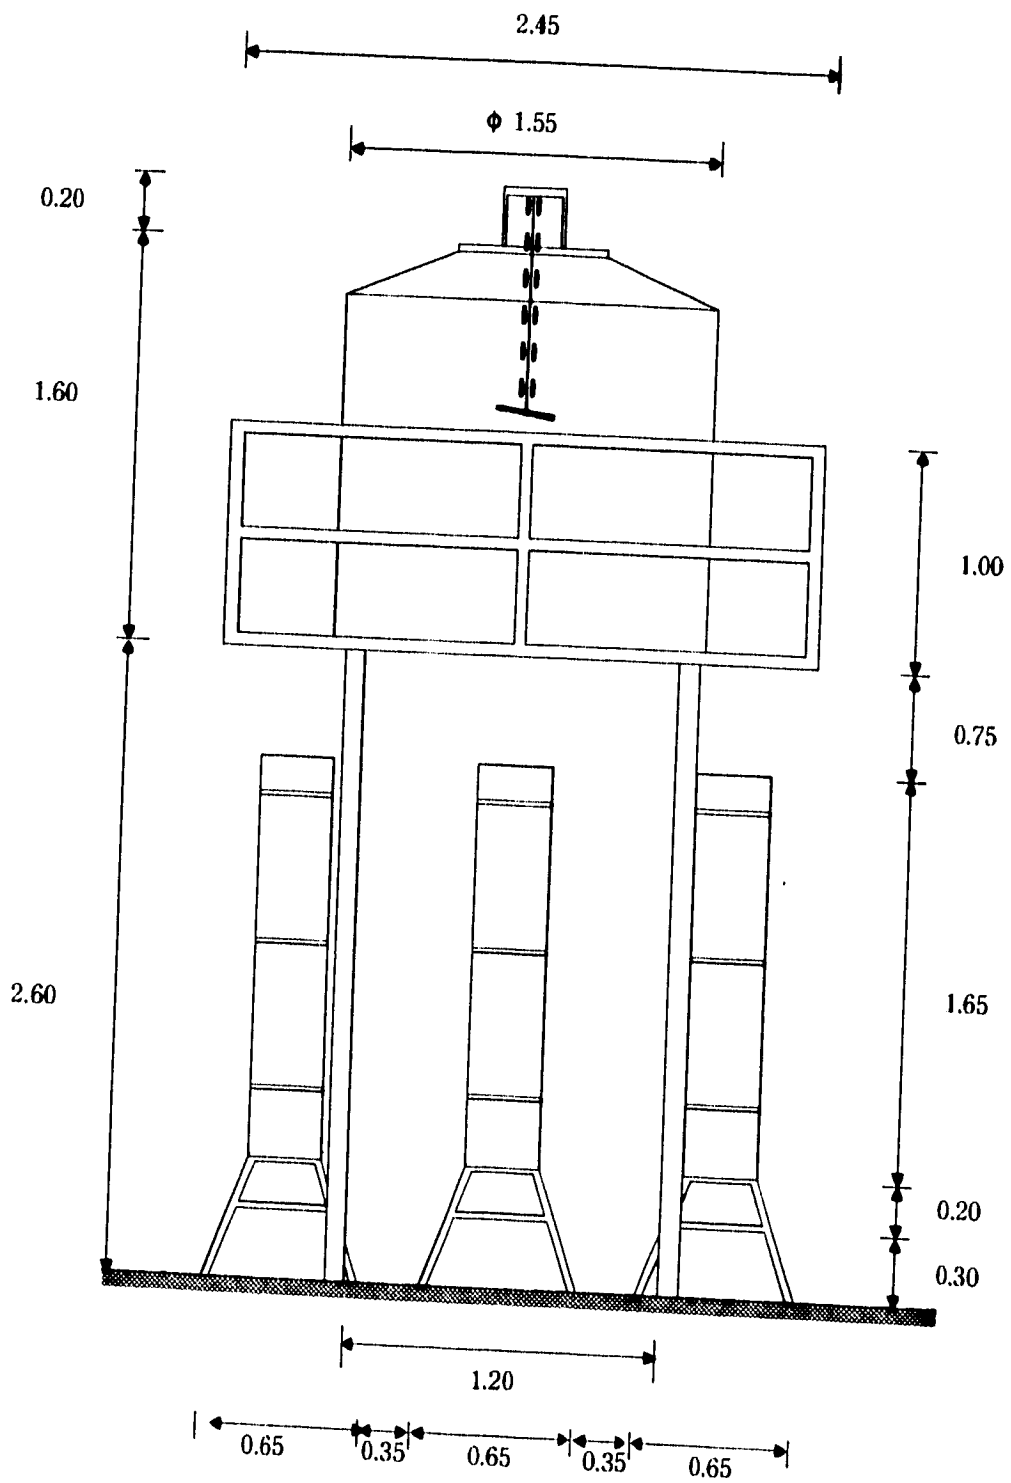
ESTRUCTURAS DE SOPORTE PARA LAS COLUMNAS DE FILTRACIÓN Y EL TANQUE MEZCLADOR.
